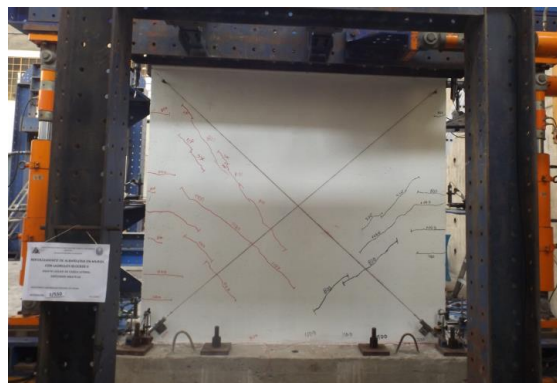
Formación de más grietas diagonales para una distorsión 1/550.
